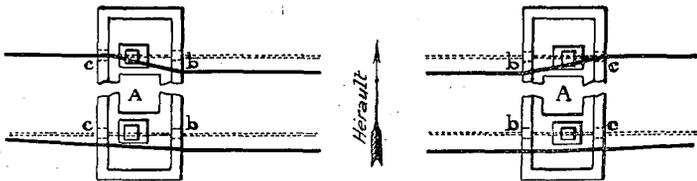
Vue en plan du pont montrant la position des câbles sur les portiques après l'ouragan.
